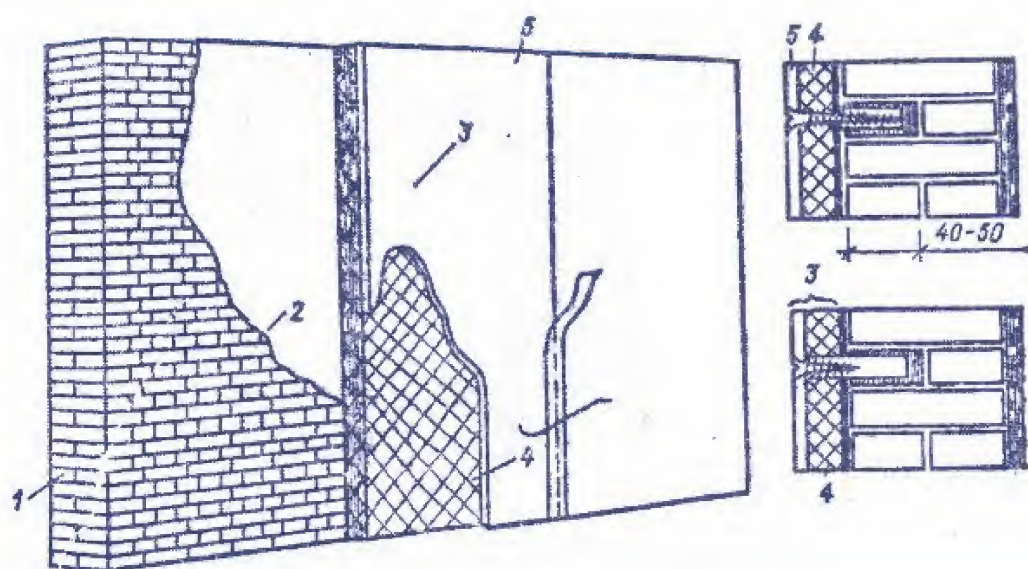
Двошарові плити для утеплення стін із зовнішнього боку ферми: 1 — оштукатурена цегляна стіна; 2 — штукатурка; 3 — теплоізоляційна панель; 4 — мінеральна вата; 5 — азбестове облицювання
